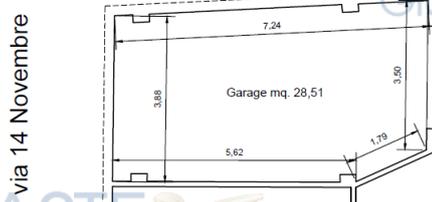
Planimetria rilevata del sub. 4 - piano interrato - non in scala
